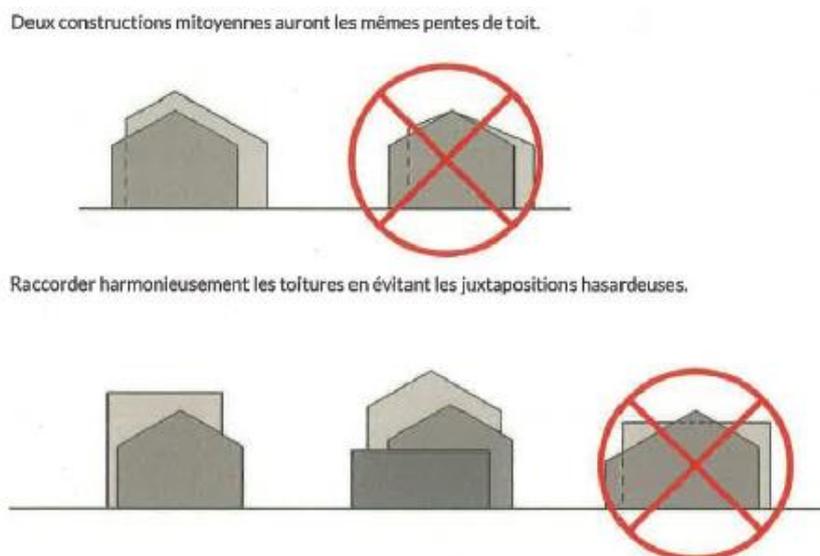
Principes acceptés ou refusés au niveau des toitures entre deux constructions mitoyennes
